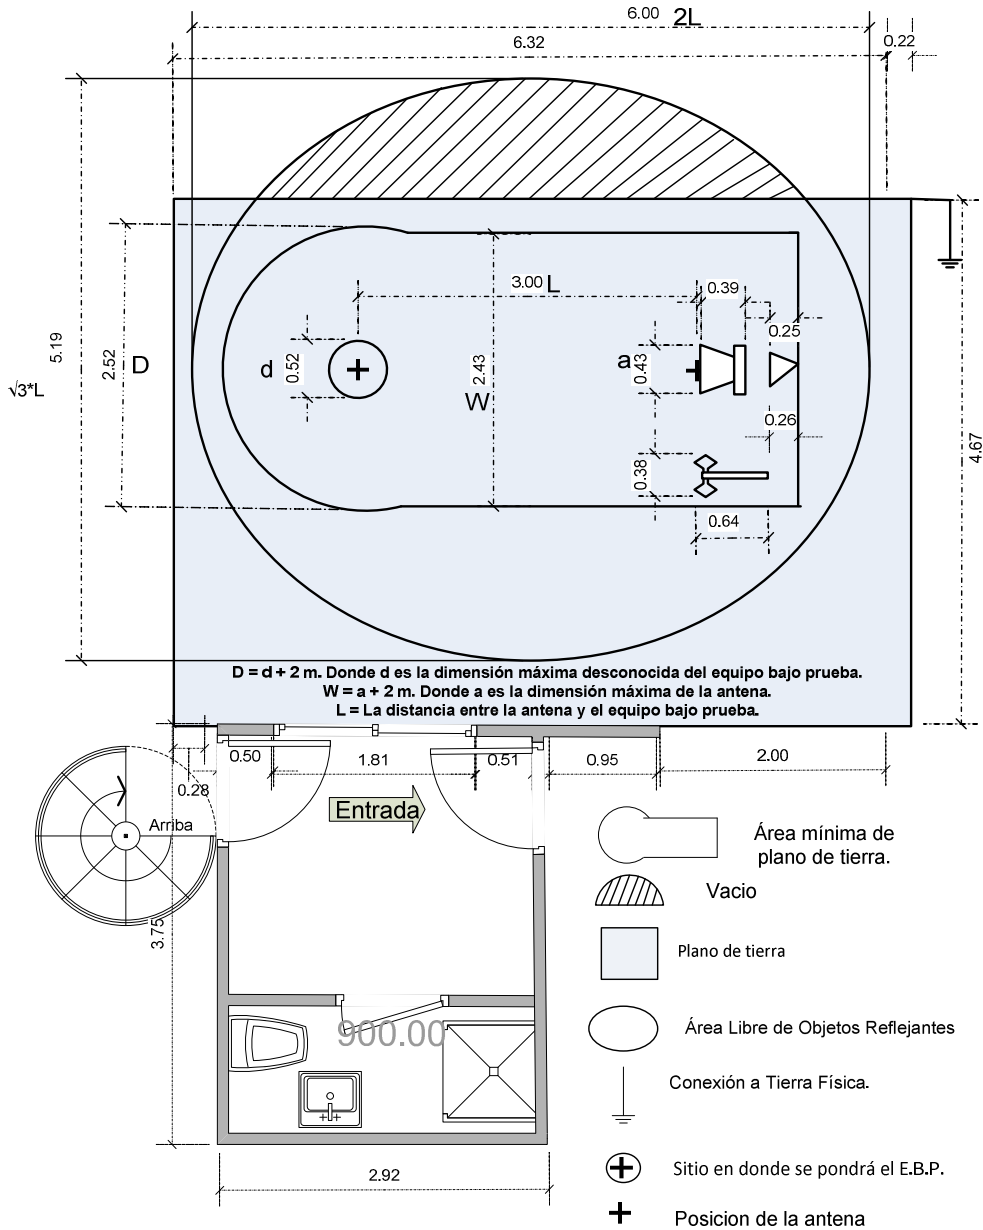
Plano de la azotea de Ivestel y del área abierta.
